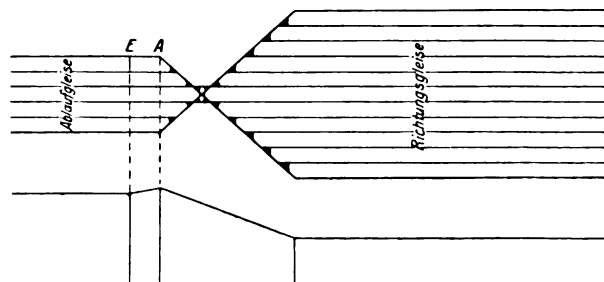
Grundriss und Längsprofil einer Ablaufanlage mit dem Abrollpunkt innerhalb der Ablaufgleise.
